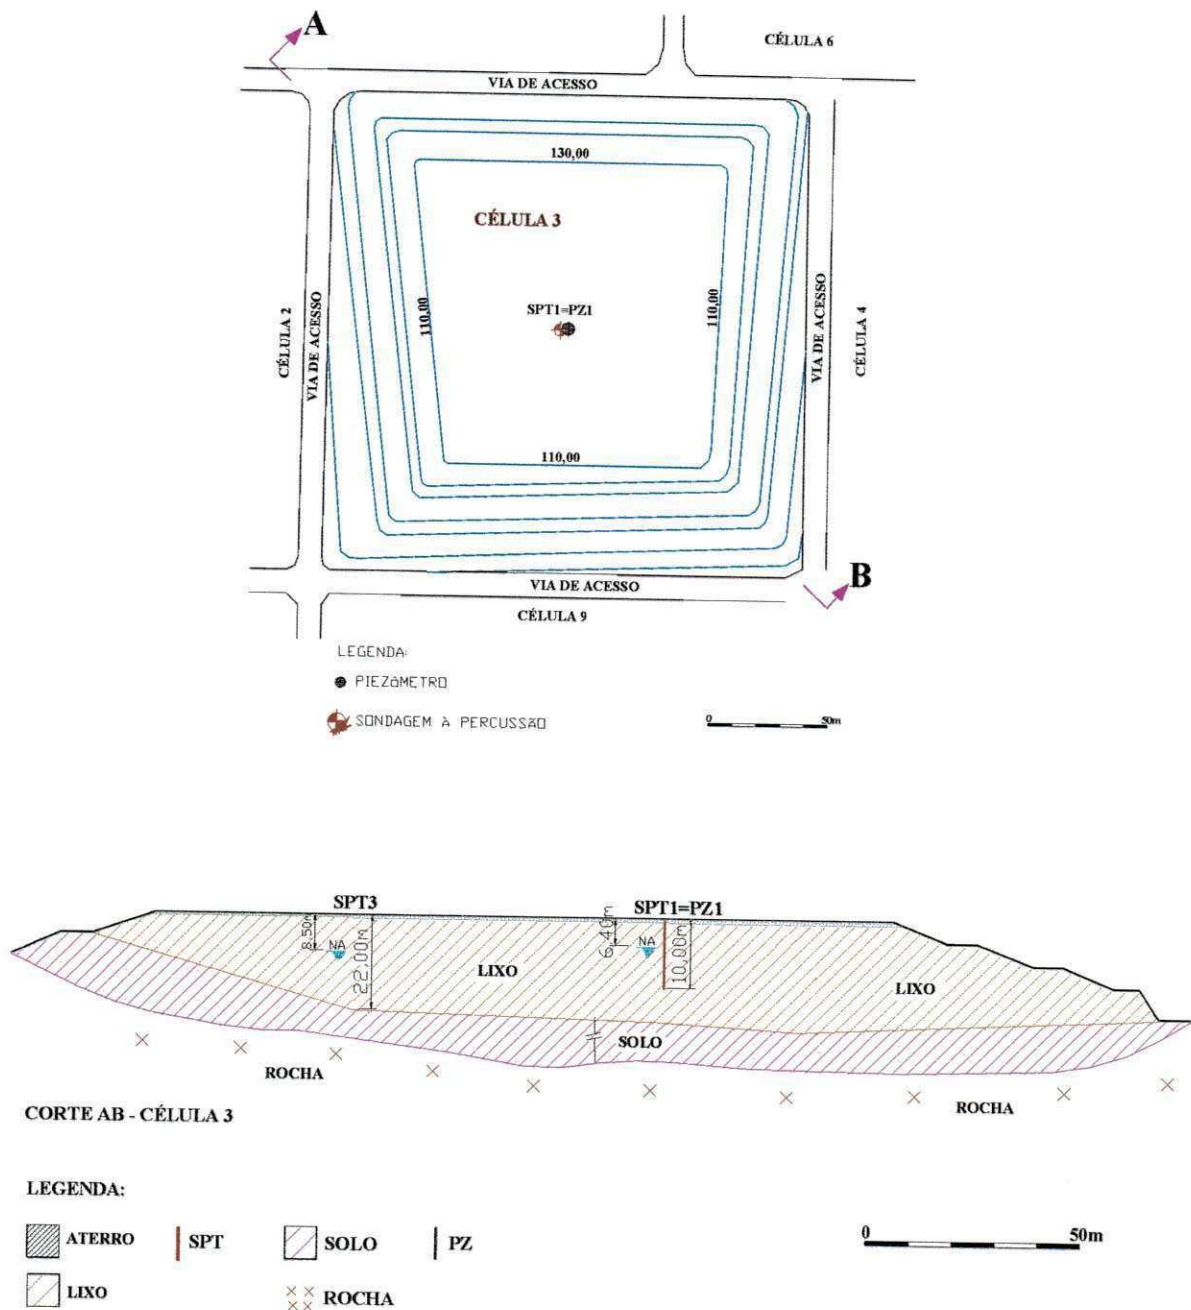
Localização e perfil do piezômetro Pz-1 instalado na Célula 3 no Aterro da Muribeca – Jaboatão dos Guararapes (PE)
